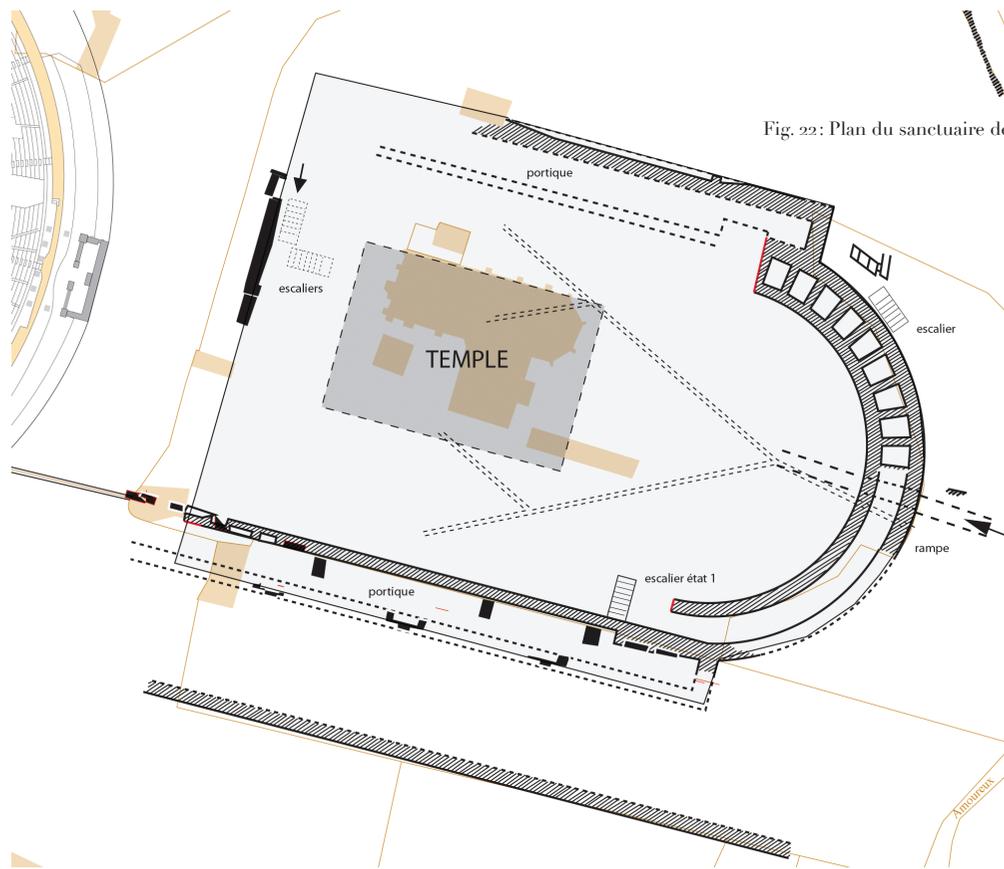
Plan du sanctuaire de Pipet, B. Helly
